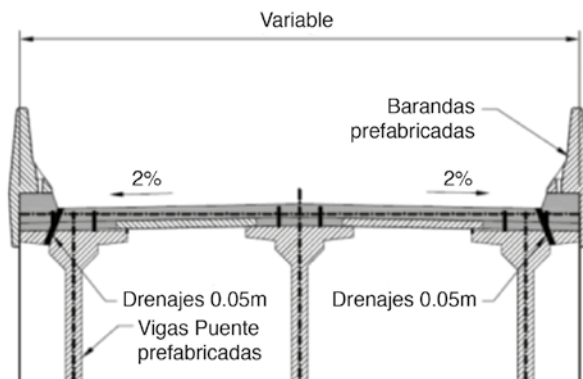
Ejemplo de barandas prefabricadas de concreto con faldones
